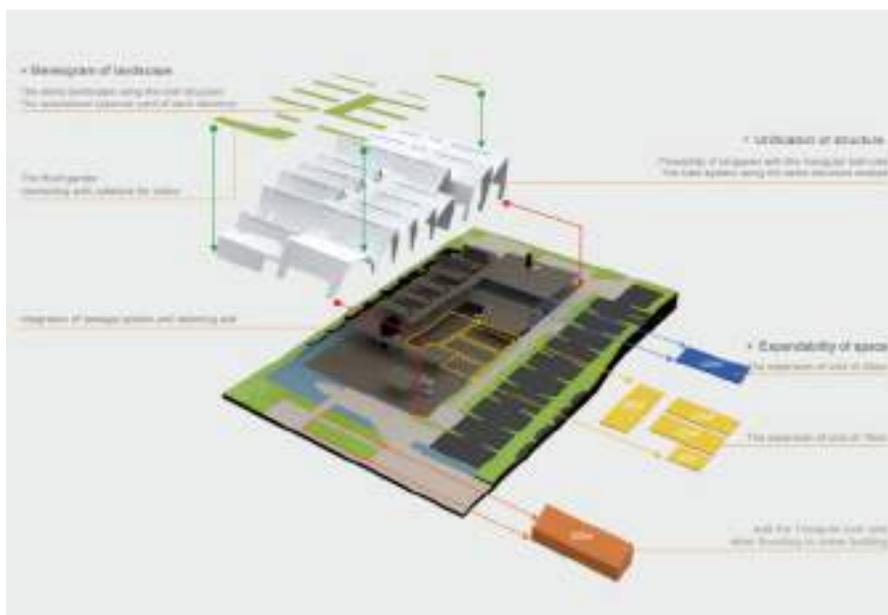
Esquema de elementos constructivos aplicados al proyecto - Design Strategy & Research Center. Plano de The System Lab (Plataforma Arquitectura, 2017)
